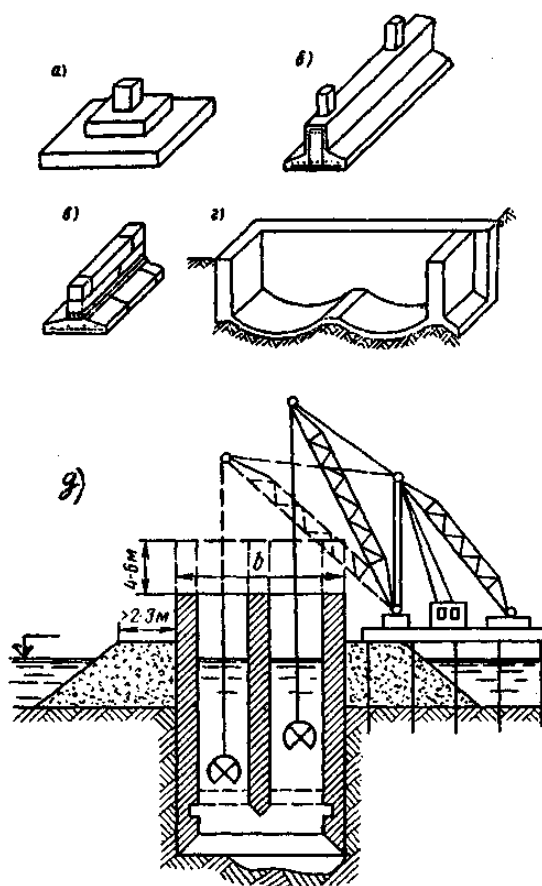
Основные типы фундаментов: а – отдельный гибкий с плоской подошвой неглубокий; б – полосовой монолитный неглубокий; в – полосовой сборный неглубокий; г – сплошной неглубокий облегченный; д – глубокий (опускной колодез) массивный.
